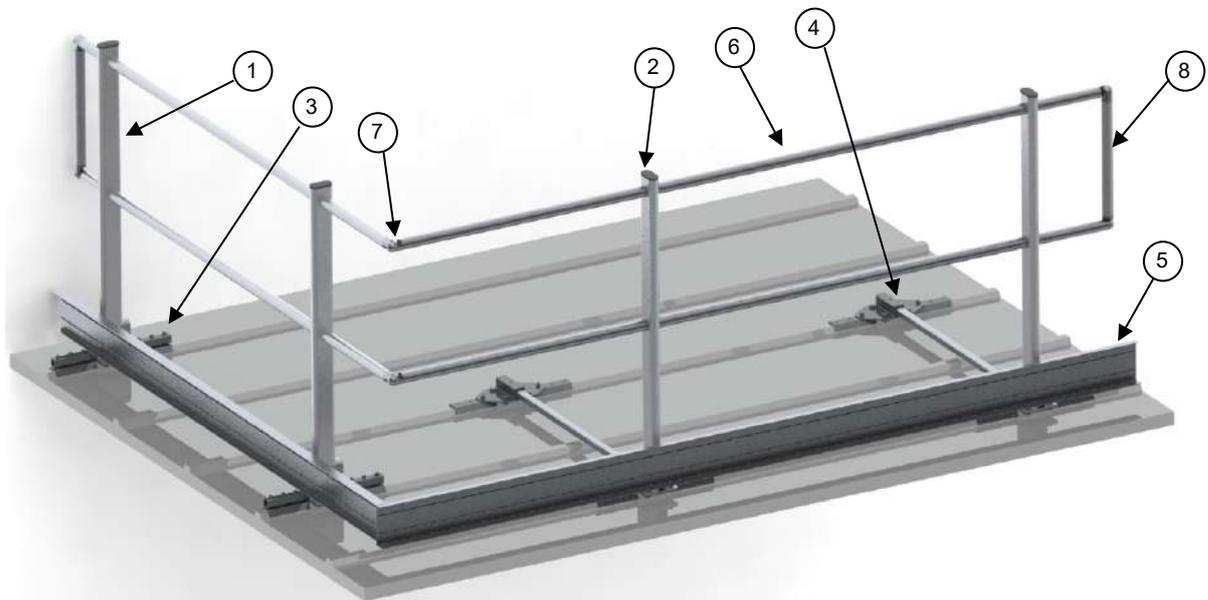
Indicaciones de los componentes constructivos del parapeto instalado sobre lámina grecada
